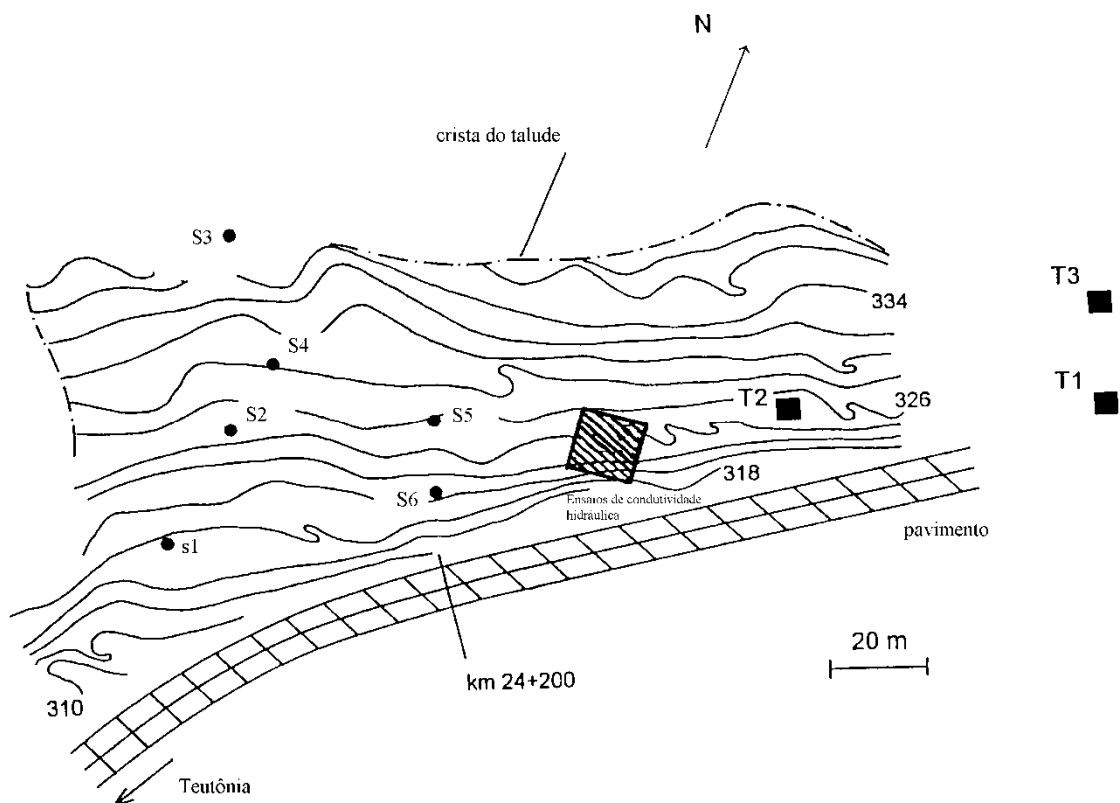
Planta baixa da encosta de Teutônia – RST-453, km 24.
